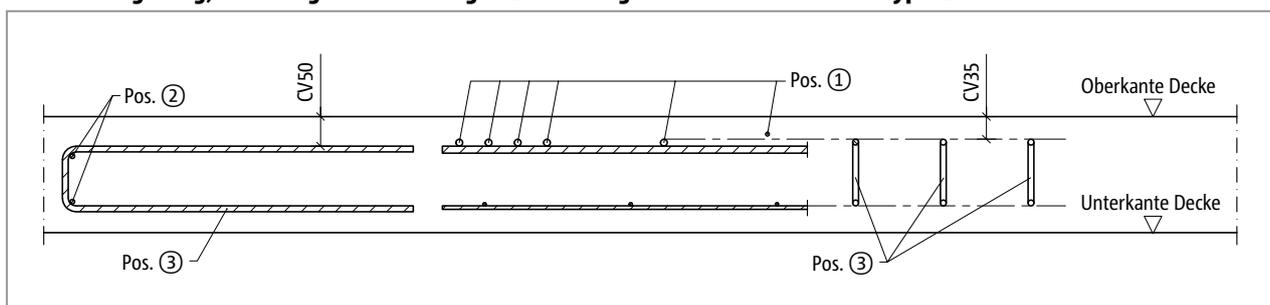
Schöck Isokorb® XT Typ C: Bauseitige Bewehrung Außenecke (Schnitt XT Typ C-L-CV50, Ansicht XT Typ C-R-CV35)
